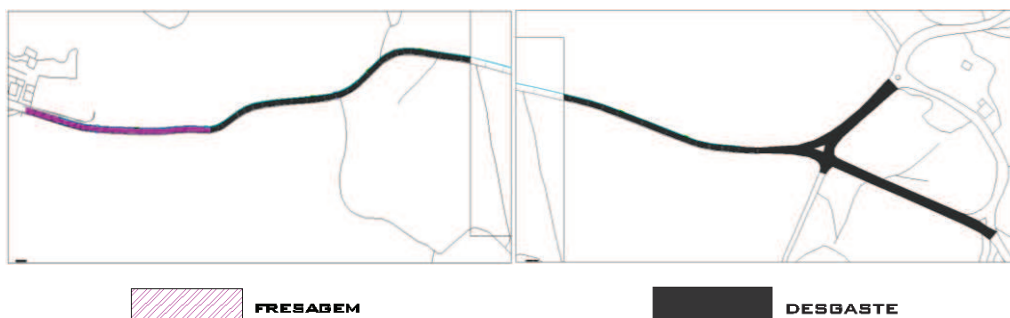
Trabalhos de pavimentação na Rua de S. Bento.
